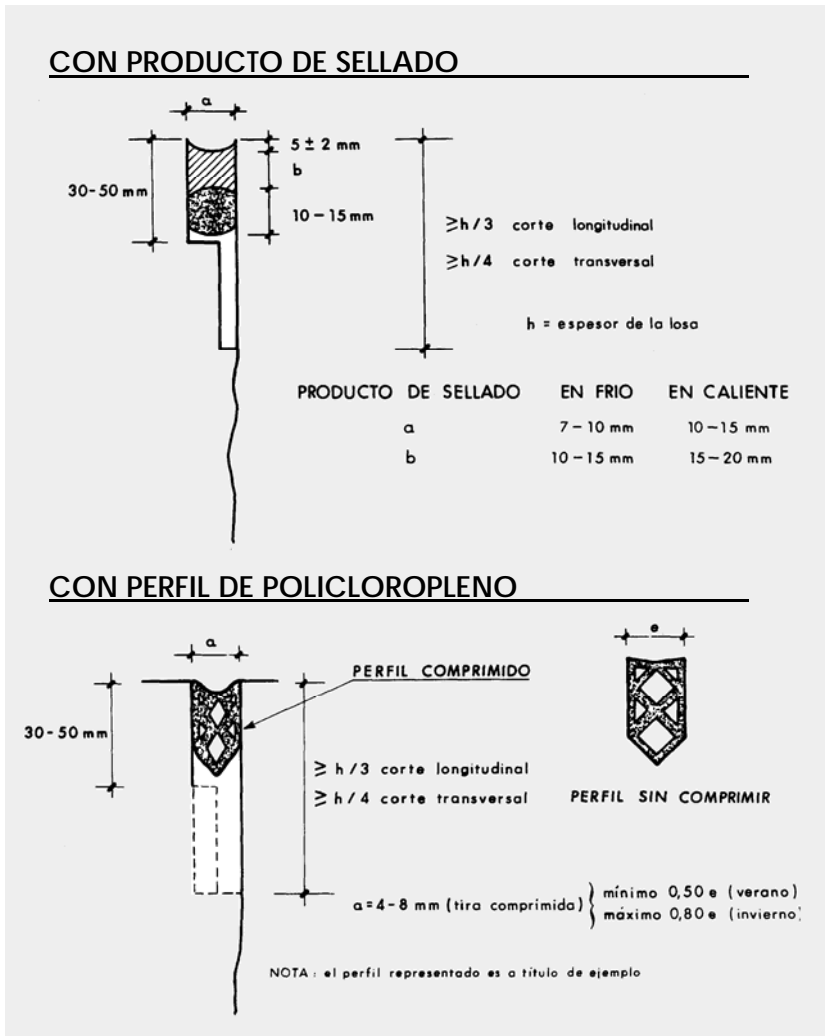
Esquemas de sellado de juntas en pavimentos de hormigón vibrado
